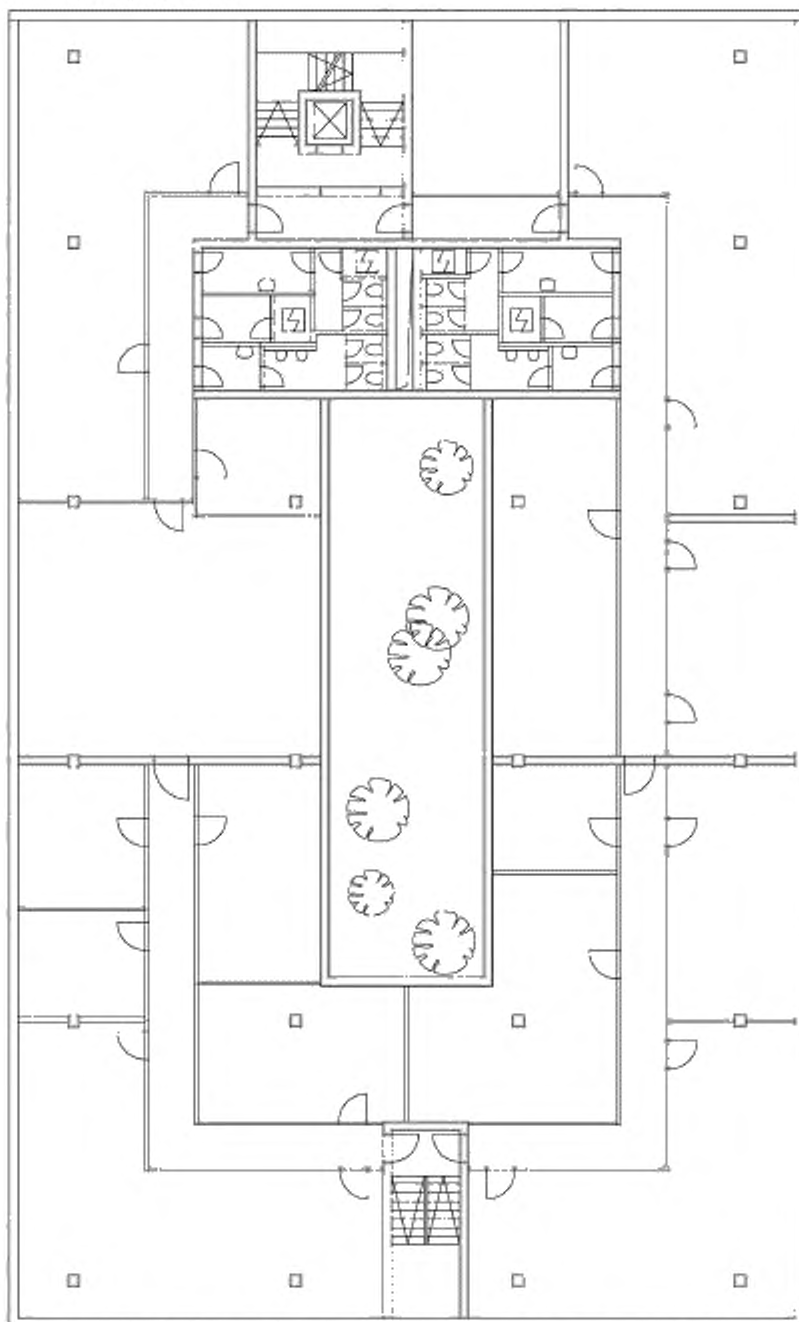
План этажа с указанием объектов, площадь которых входит в площадь внутренних конструкций
